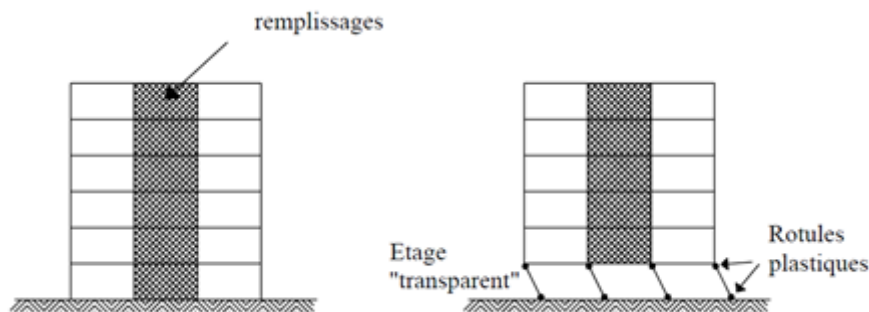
A gauche : régularité en élévation. A droite : niveau rez de chaussée flexible ou mou.
